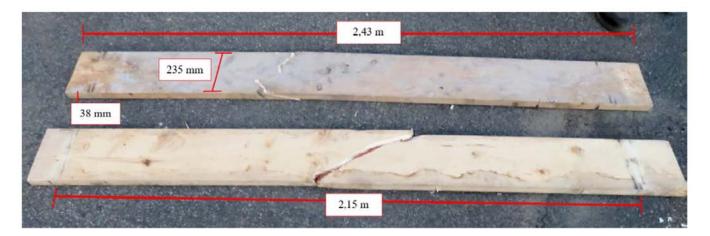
Madriers utilisés comme plancher de travail Source : CNESST
